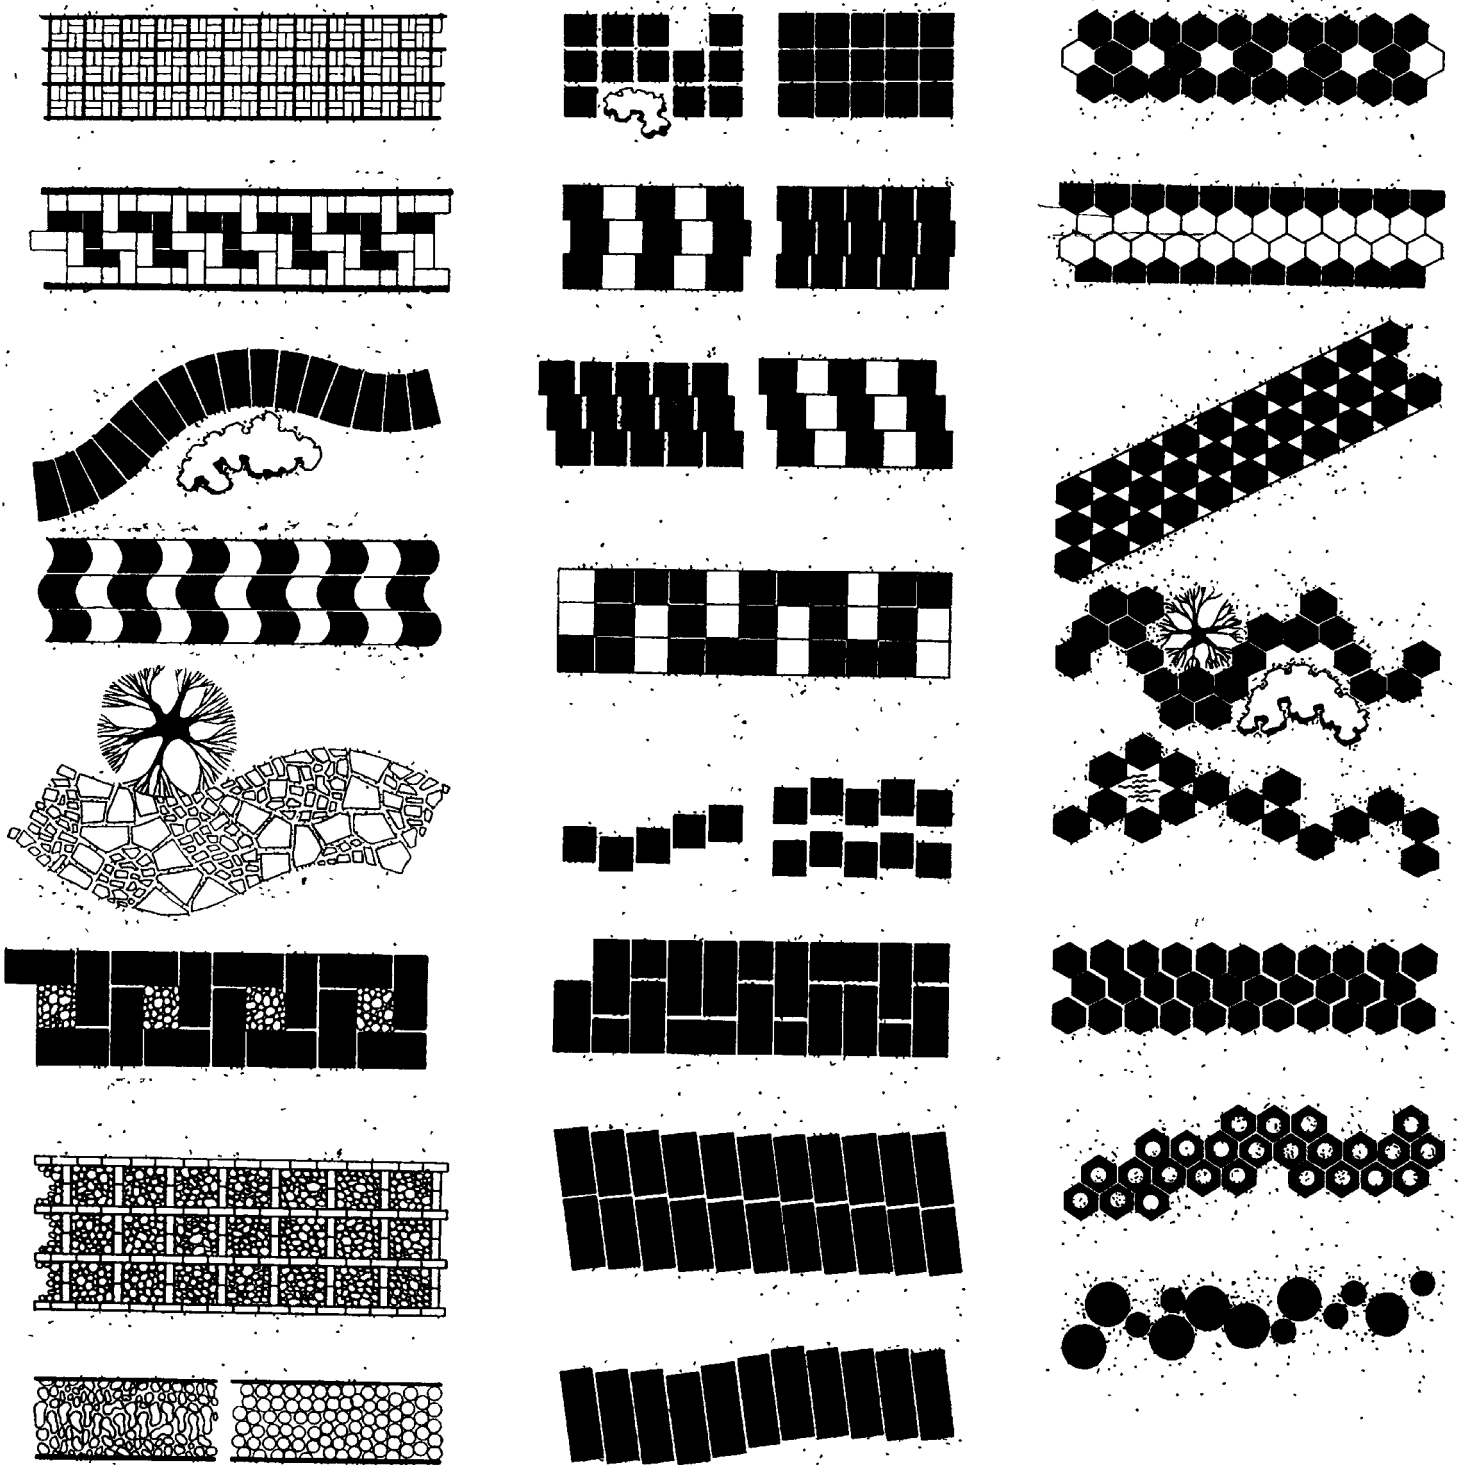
Варианты раскладки плит в покрытиях дорожек и площадок
